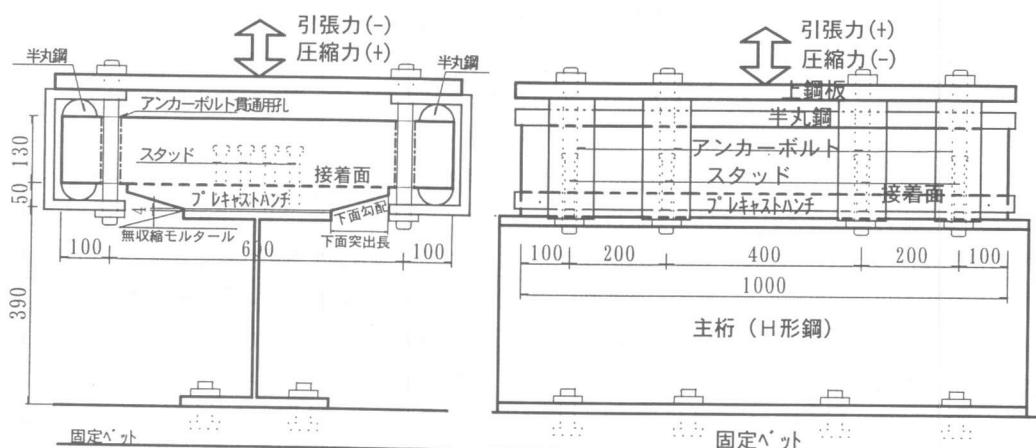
交番載荷試験用供試体の形状寸法および載荷位置・載荷方法 (単位mm)
